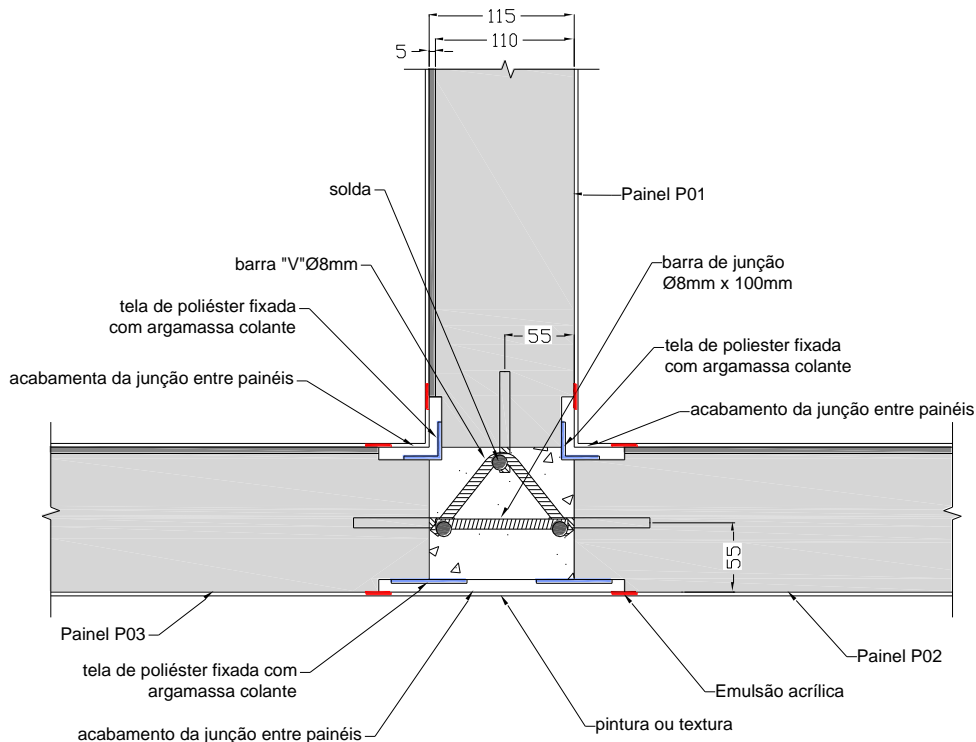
Exemplo de acabamento de junta entre painéis de parede (vista em planta)
